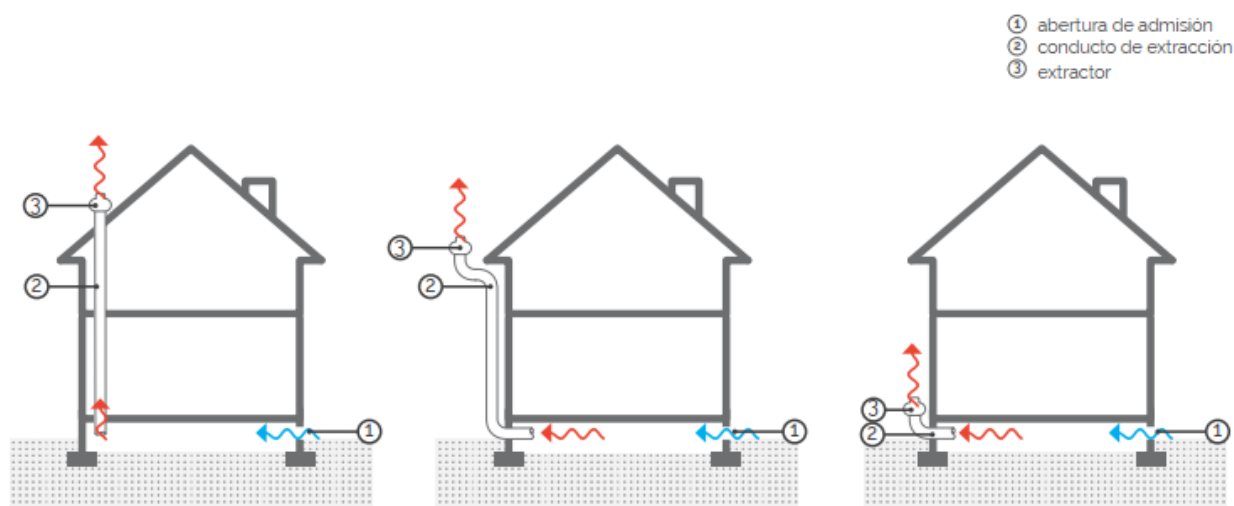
Conducto de extracción con extractor hasta cubierta por el interior del edificio (izquierda.), por el exterior (centro) y en fachada (derecha.). Fuente: [27].
